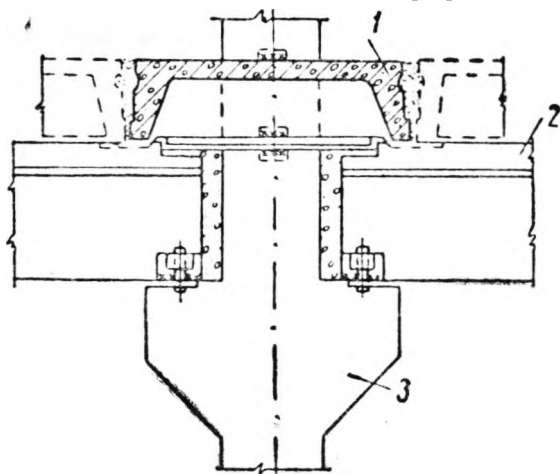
Узел сборного железобетонного каркаса многоэтажного производственного здания при ригельной схеме
